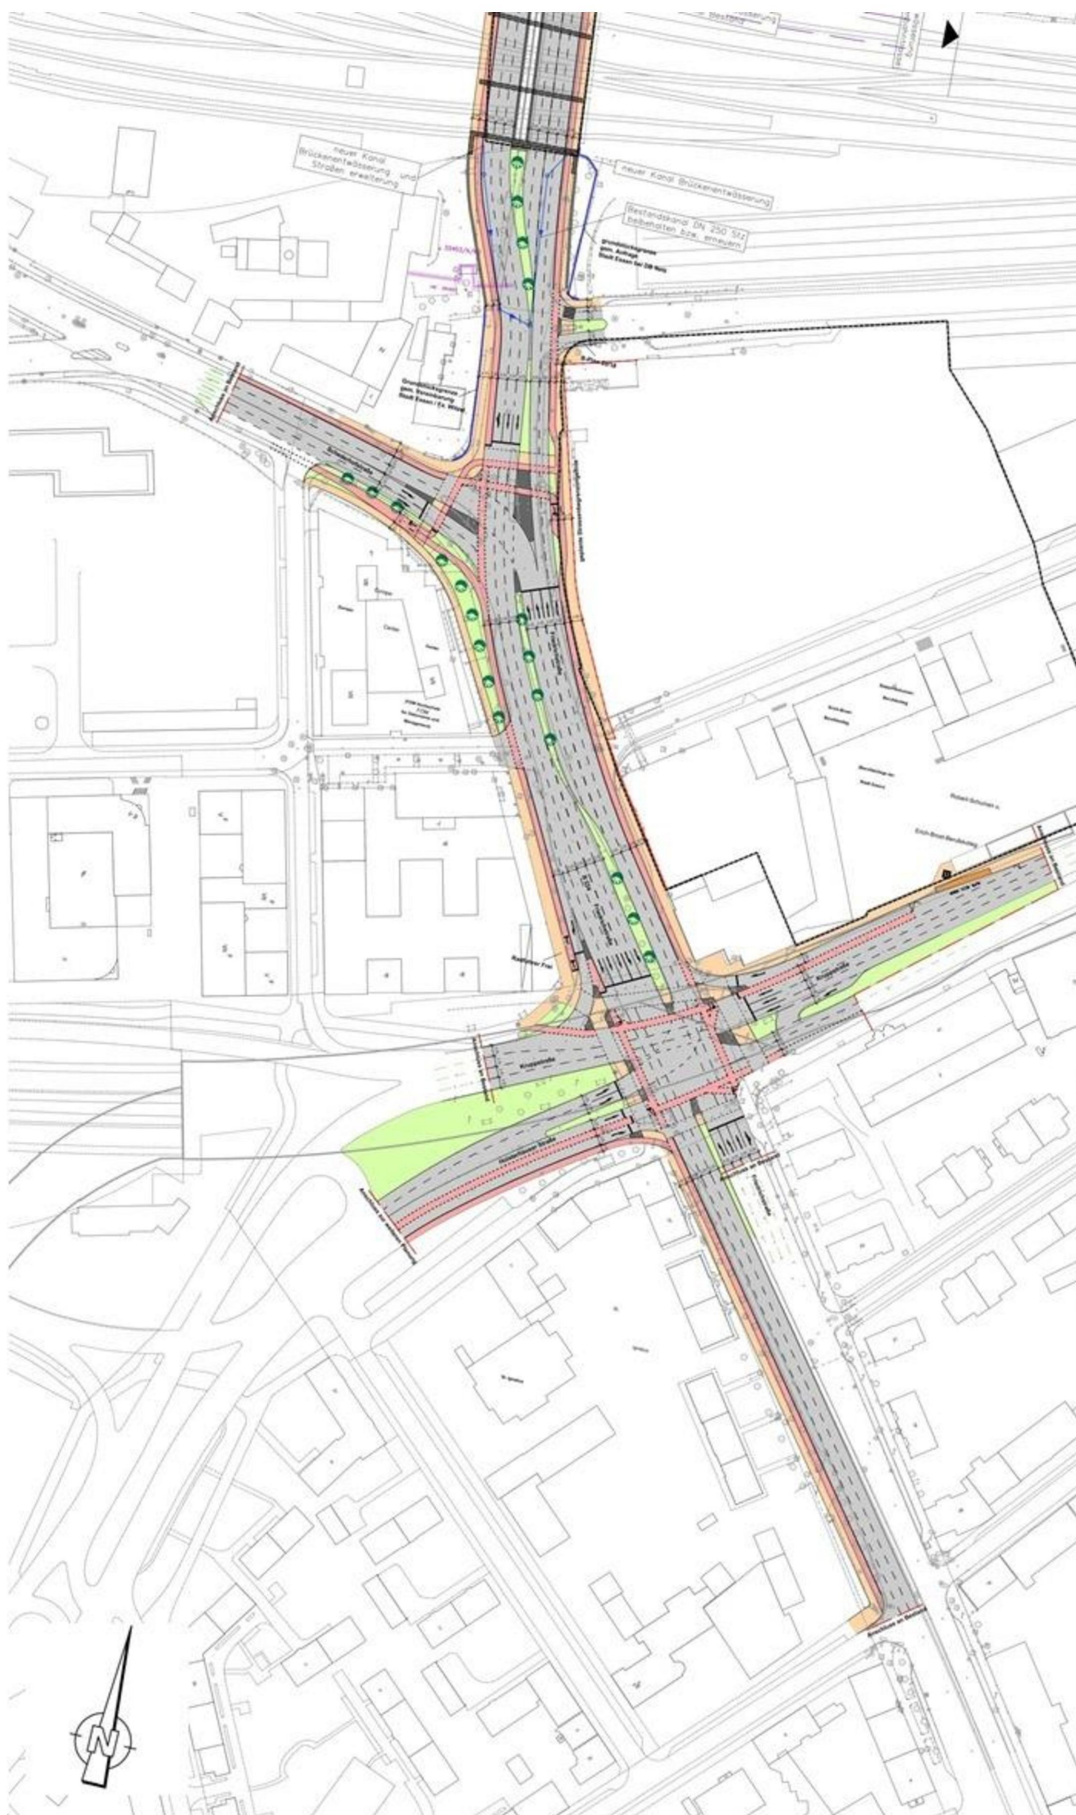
Straßenausbau nach dem Entwurf des Büros Schüßler-Plan aus Köln
